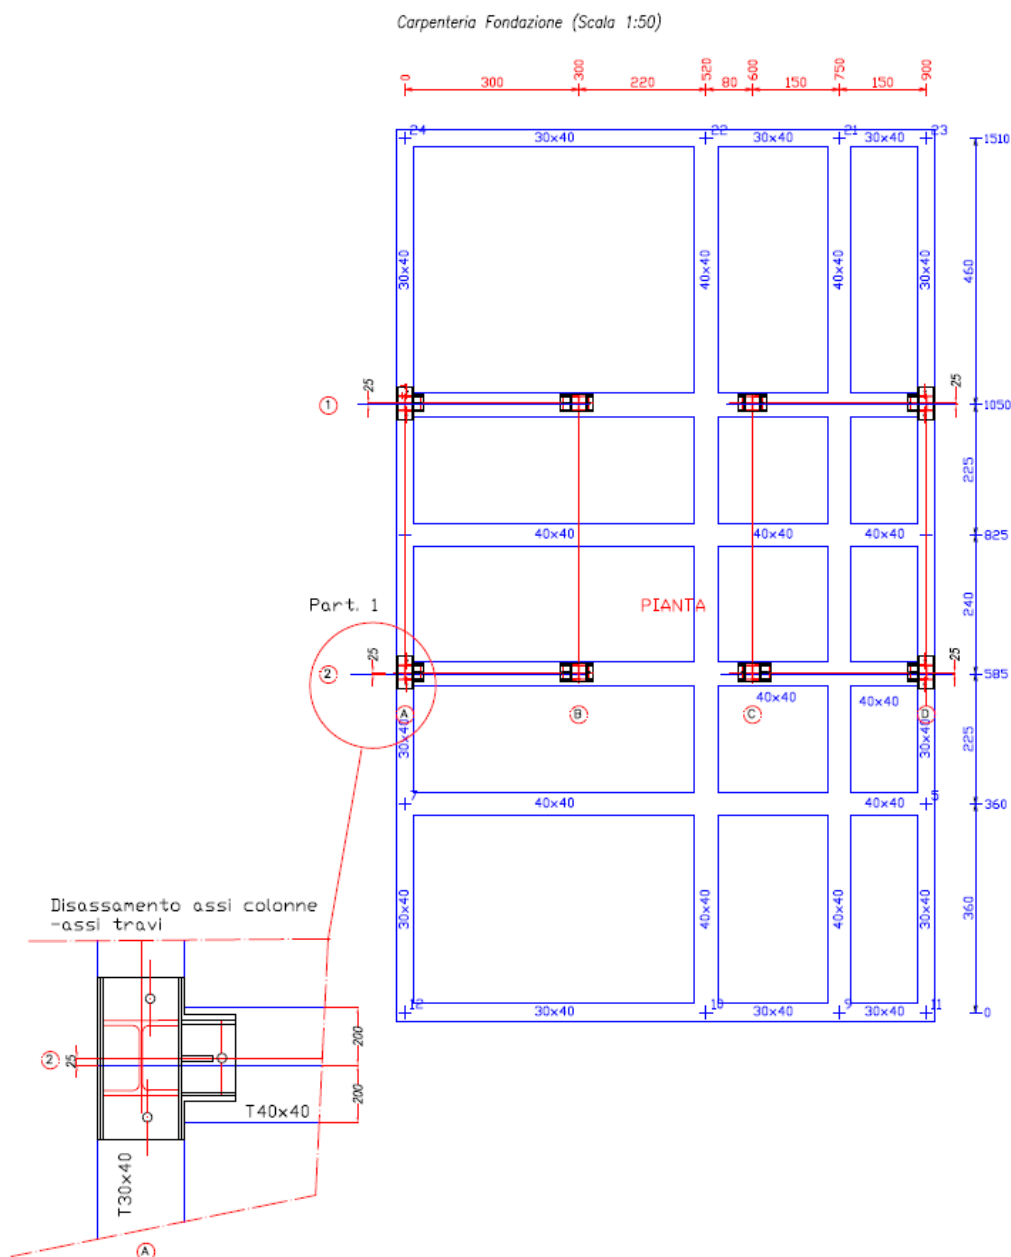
Travi di fondazione secondo disegno originale (ID ANS-002-006-rev02) del 02 Giugno 2007.
